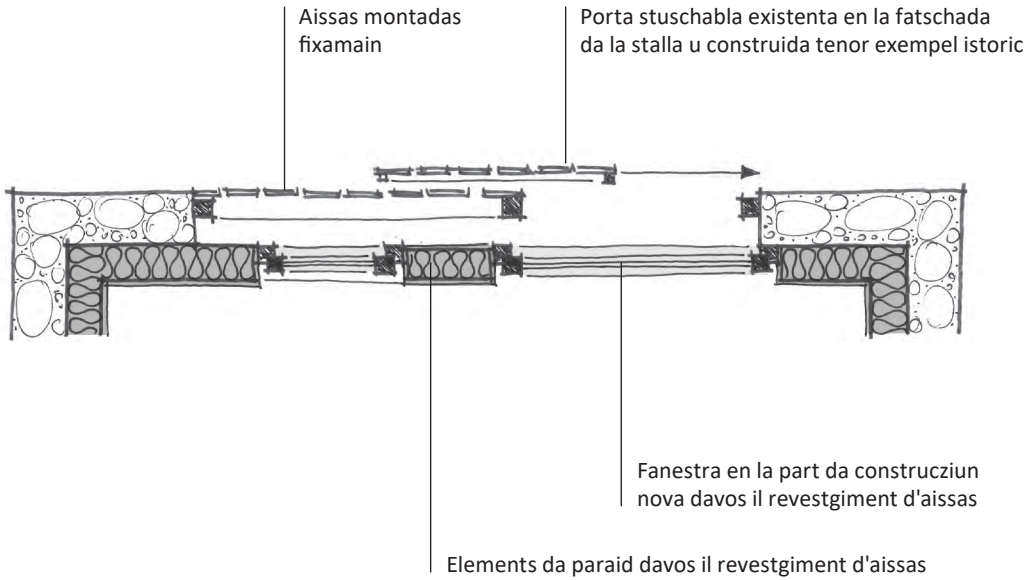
Skizza da princip dal clavà: Fatschada da vaider davos aissas da fatschada cun distanzas (plan orizzontal).
